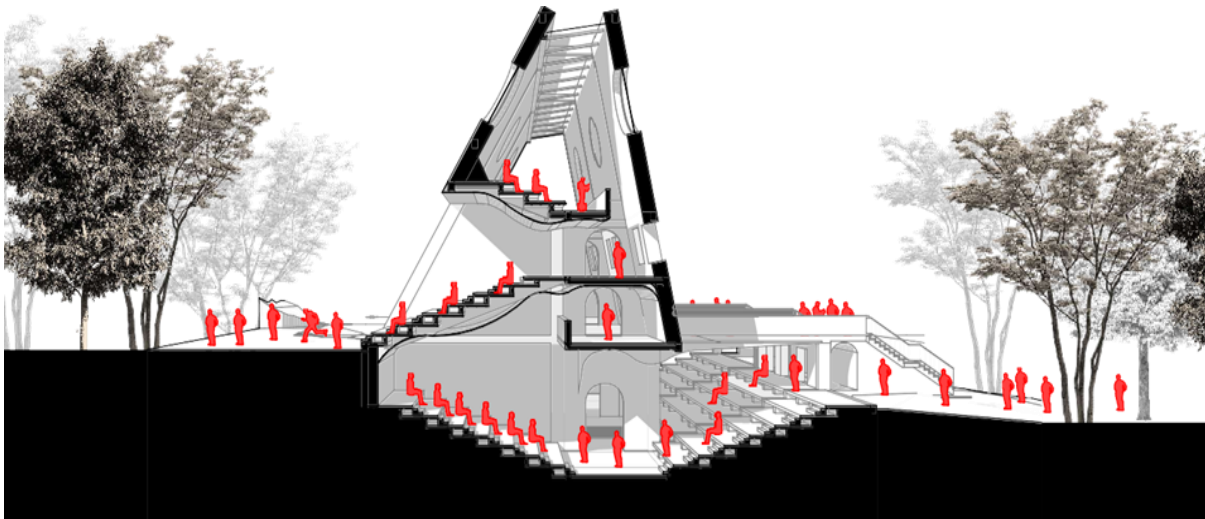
Corte fugado. Propuesta arquitectónica la fachada como espacio habitable. –
